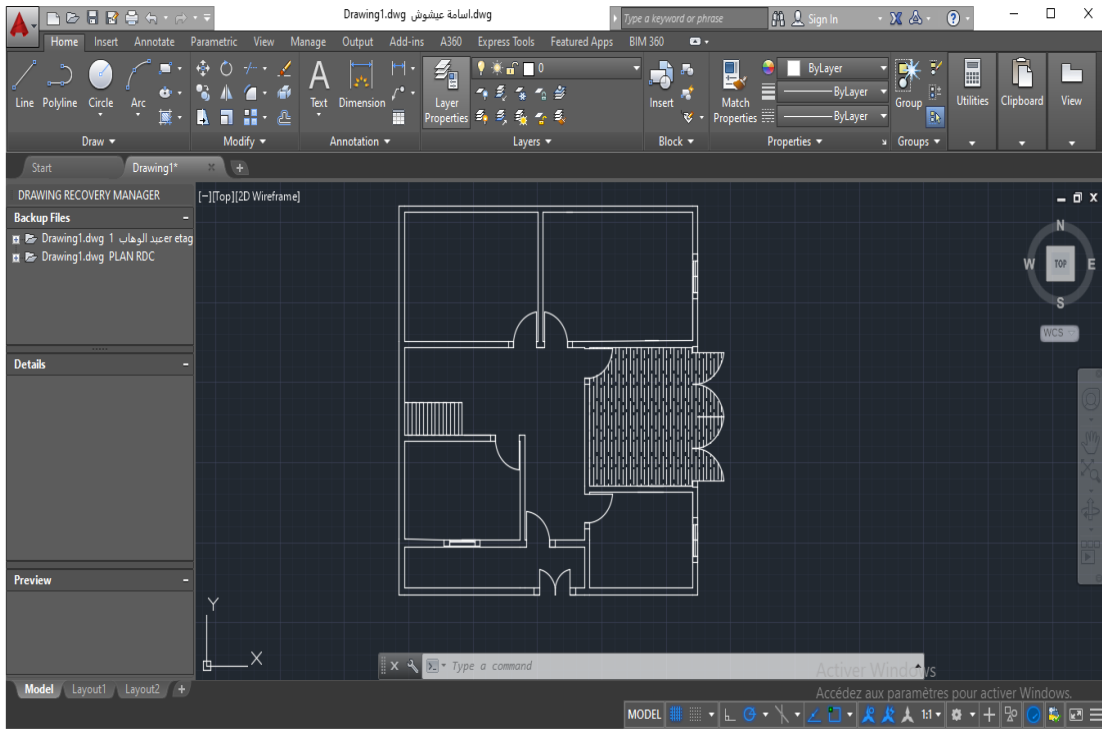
La conception du rez-de-chaussée de laboratoire (Essalam).
